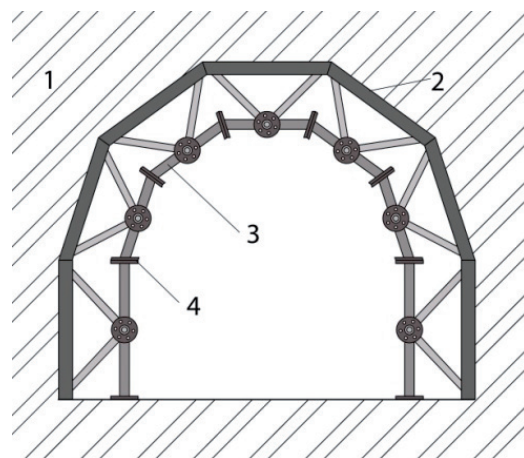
Система сталезалізобетонних структурних кріплень: 1 – ґрунтова порода; 2 – сталезалізобетонна плита; 3 – структурна решітка; 4 – фланцеве з'єднання
